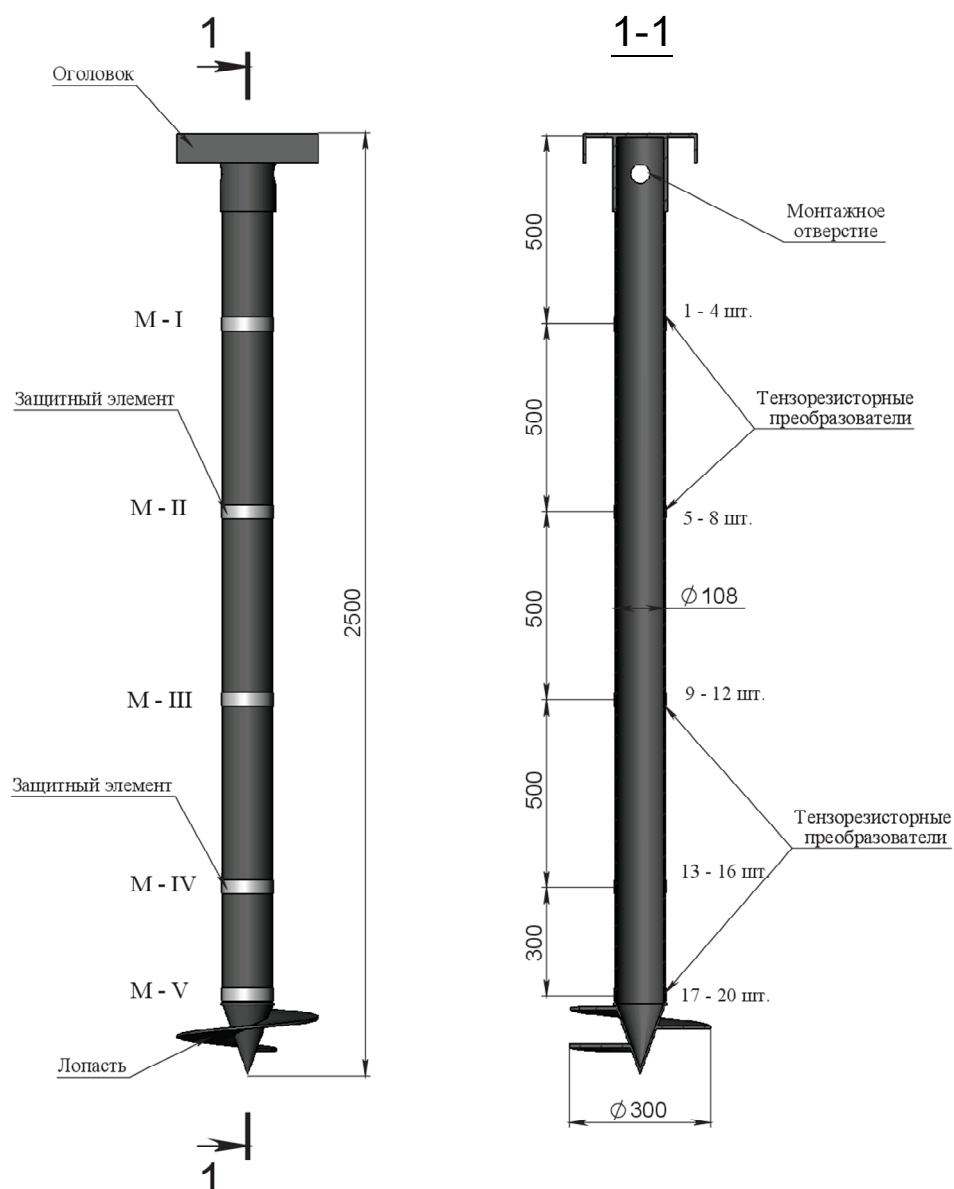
Схема конструктивного решения винтовой тензометрической сваи:
